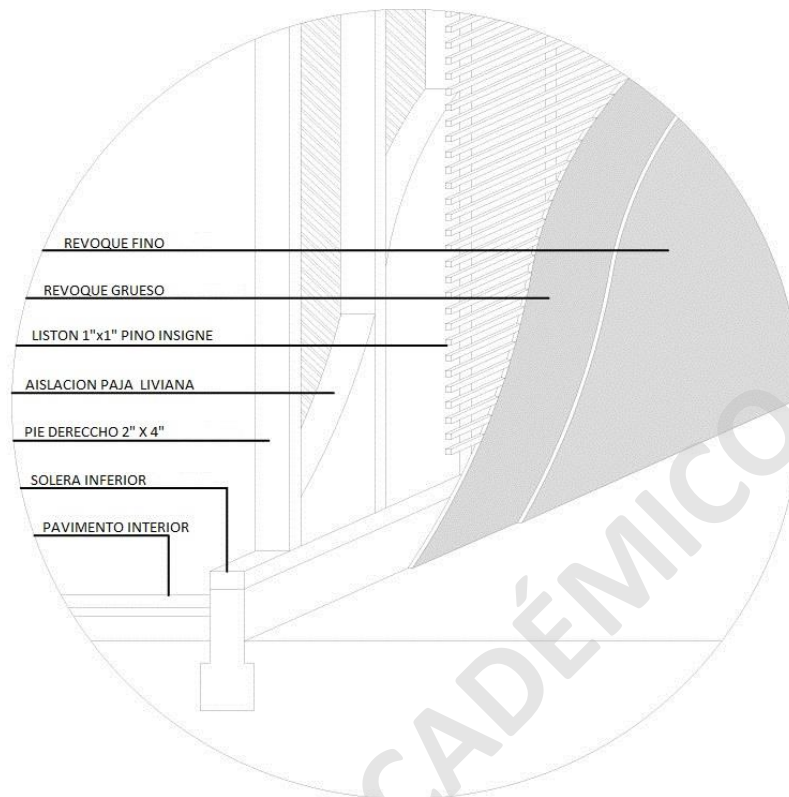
Escantillón sistema constructivo Quincha Alivianada. Fuente: Propia
